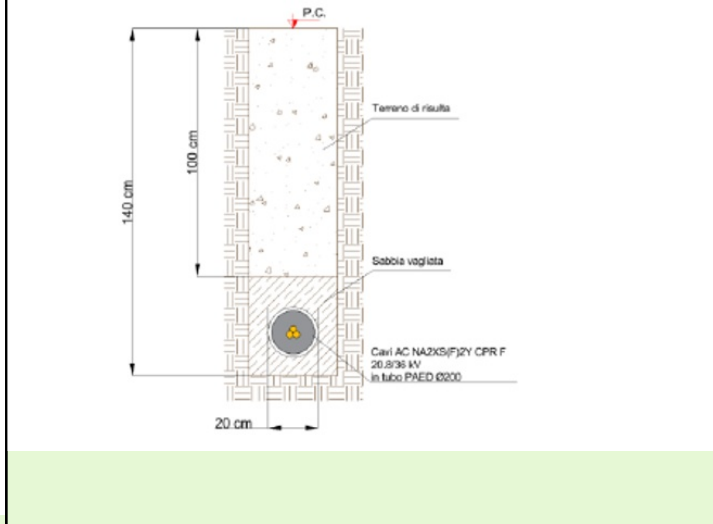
Sezione di cavidotto 36kV tra impianto AGV e SE RTN Bondeno.
